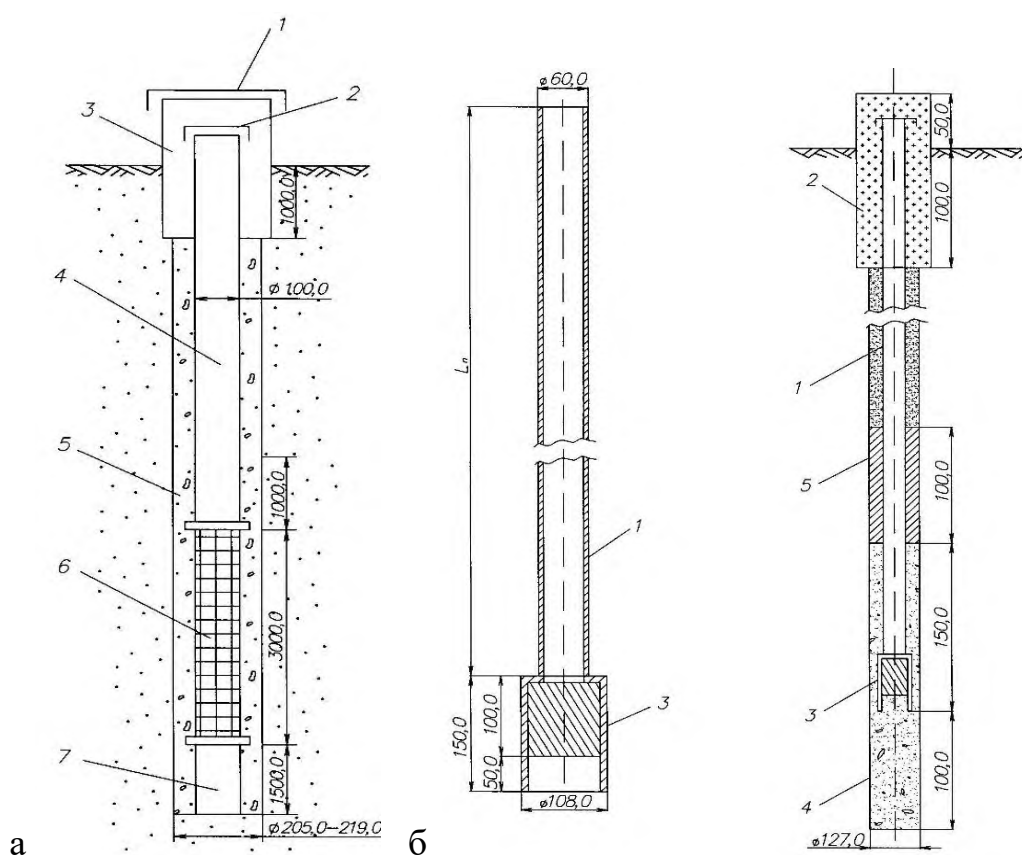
Пьезометры в дамбах накопителя: а - с проволоочной обмоткой фильтра; 1 – крышка оголовка; 2 – крышка пьезометра; 3 – теплозащитный оголовок; 4 – труба пьезометра; 5 – обсыпка фильтра; 6 – фильтр; 7 – отстойник; б - конструкция и схема установки пьезометра в дамбах накопителя с пористым фильтром; 1 – труба пьезометра; 2 – теплозащитный оголовок; 3 – фильтр из пористого бетона; 4 – водоприемная засыпка; 5 – глиняная пробка
